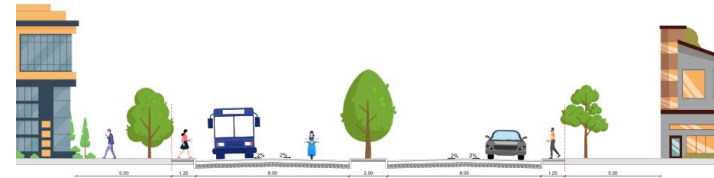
Sección A-A vía secundaria del Terminal Terrestre.
